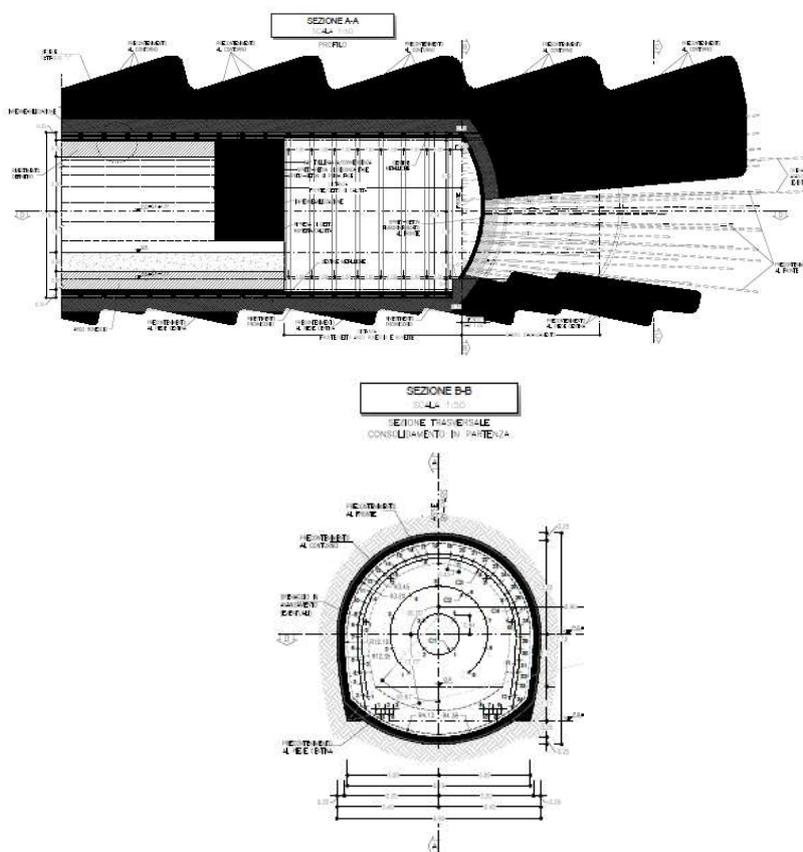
Sezione tipo C2p bypass area di sicurezza
